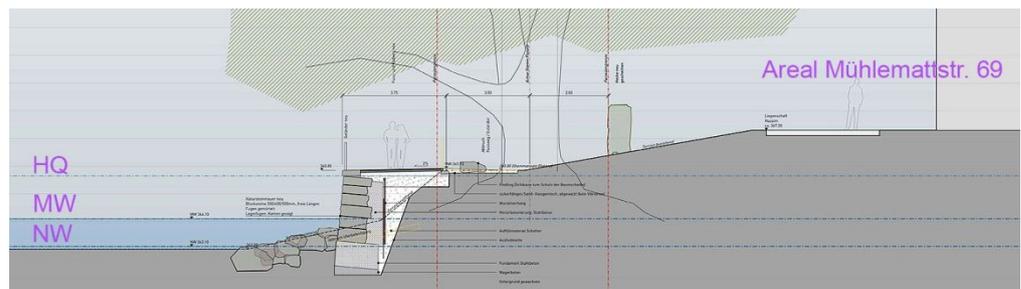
Schnitt K-K', Aare-Uferweg-Liegenschaft Mühlemattstrasse 69-73 (Details s. Aktenauflage)
